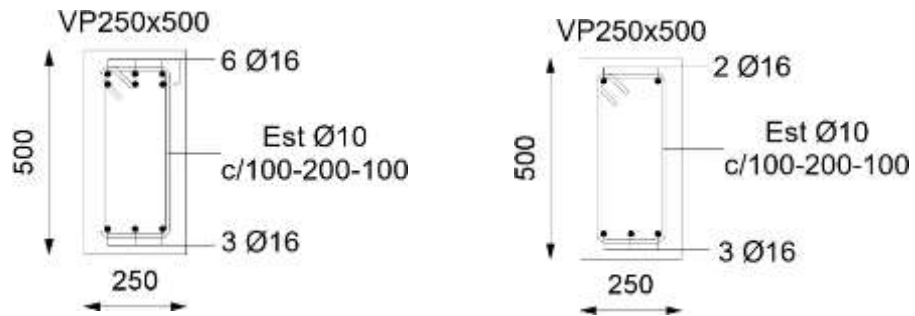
Secciones transversales de la viga. [Elaboración propia]
